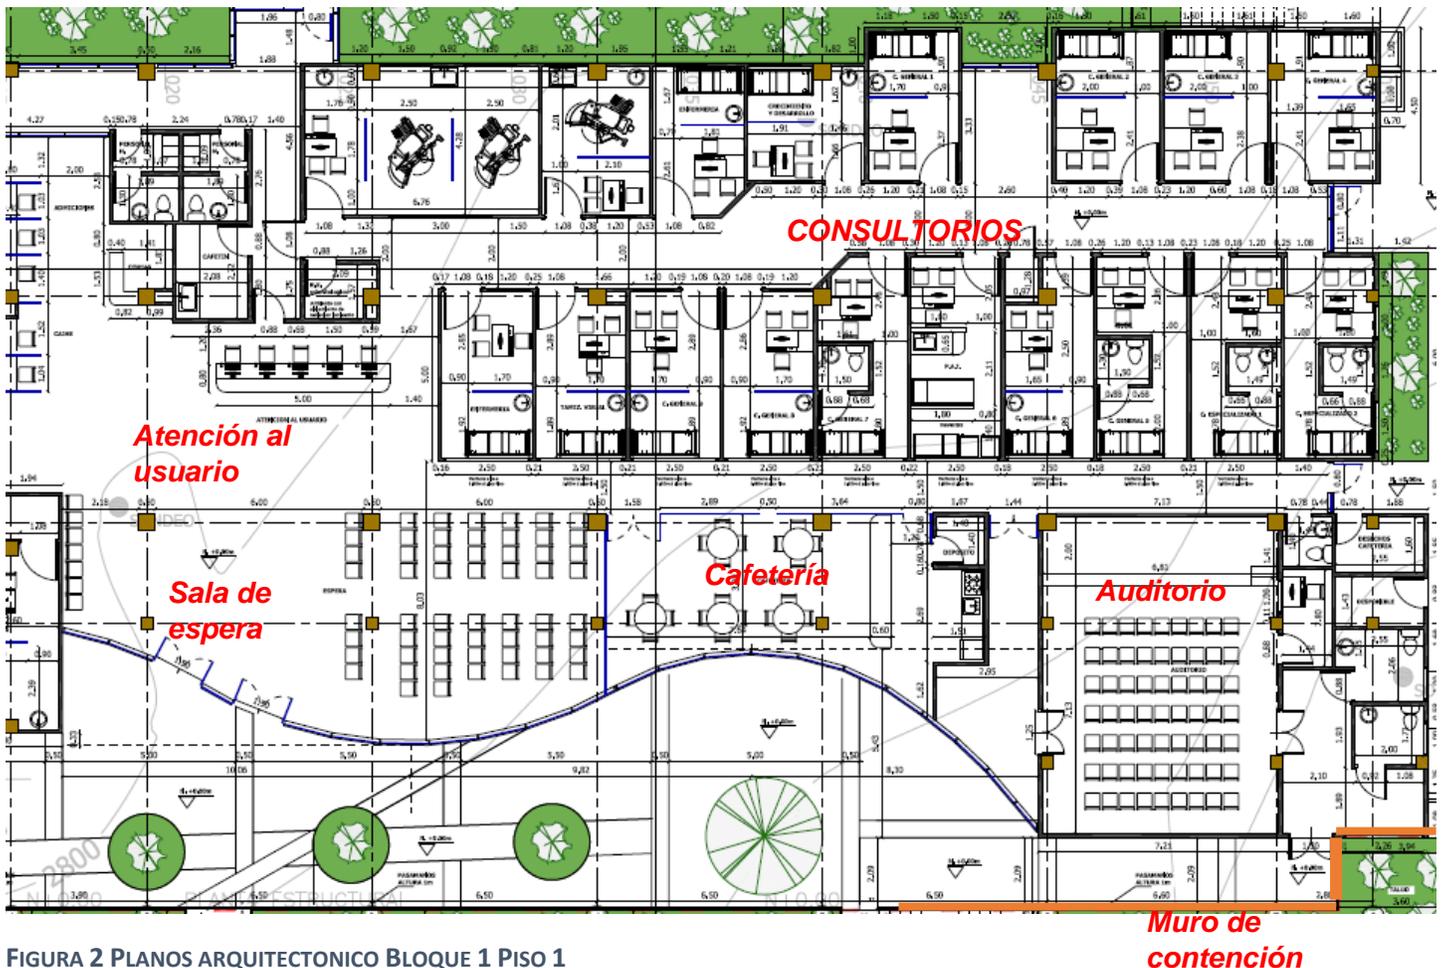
PLANOS ARQUITECTONICO BLOQUE 1 PISO 1
